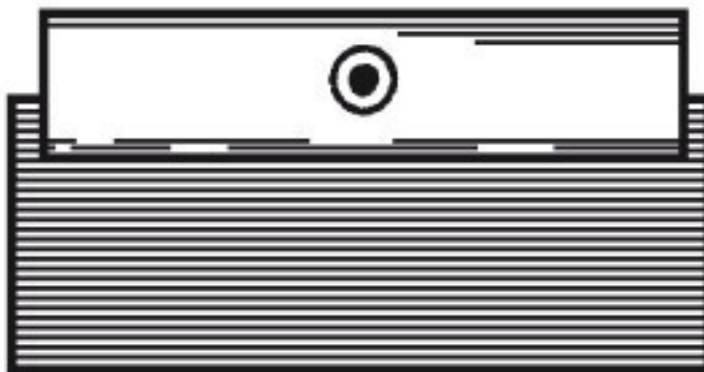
Специальный шпатель для заделки швов на перекрытиях
